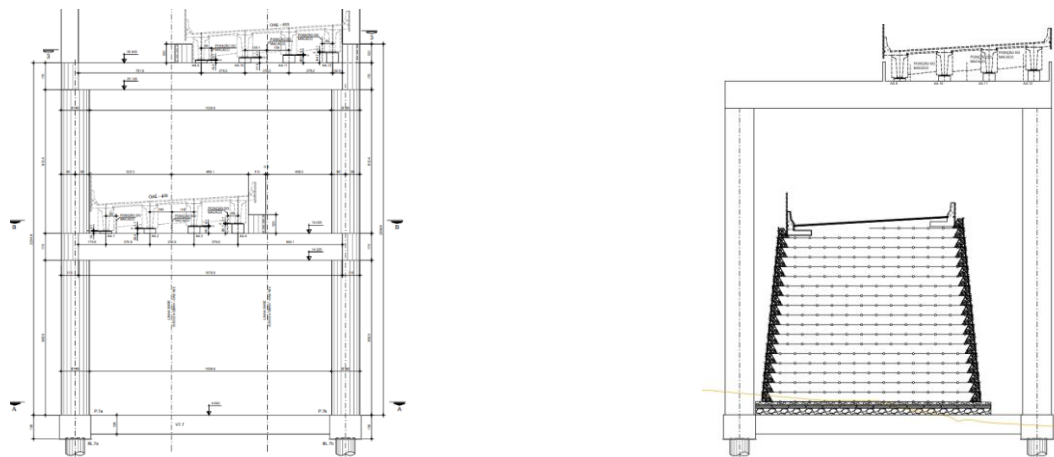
Seção transversal original em beliche e alternativa com pista inferior em solo reforçado. Fonte: Autores
